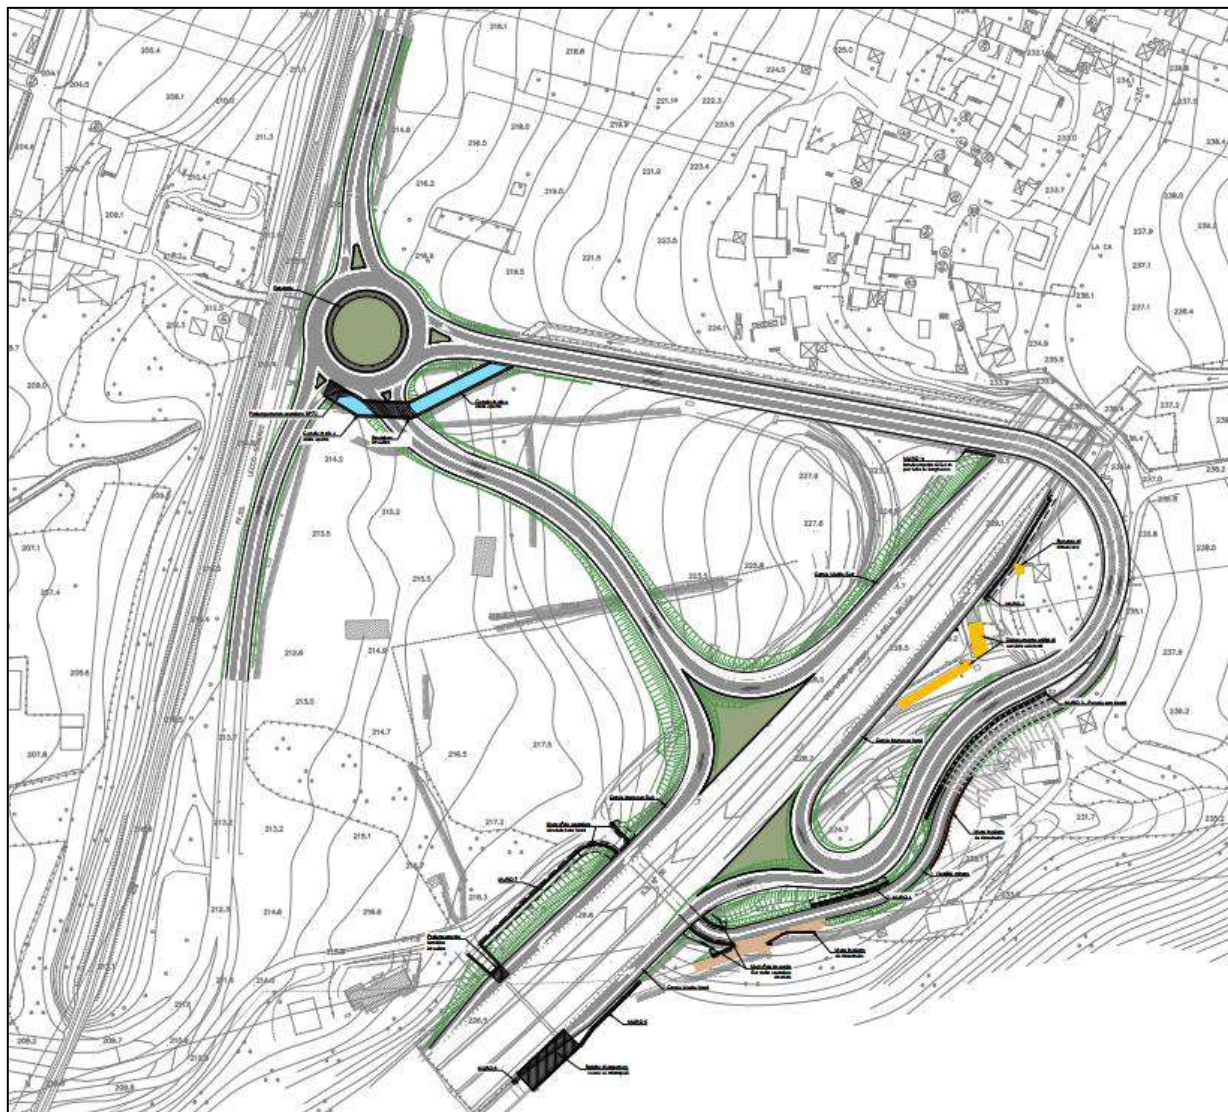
Planimetria di progetto (Fonte: Lista di Controllo)
